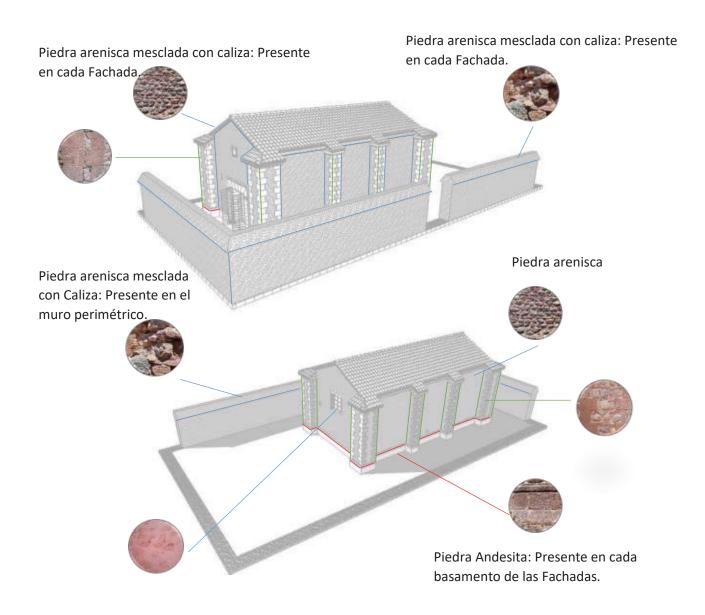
Esquema grafico de los tipos de piedra presente en las fachadas del almacén mayor de pólvora. Fuente Elaboración propia.
